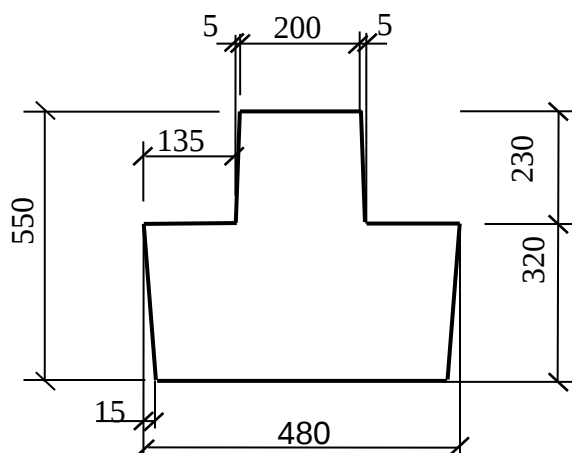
Поперечний переріз ригеля будівлі
